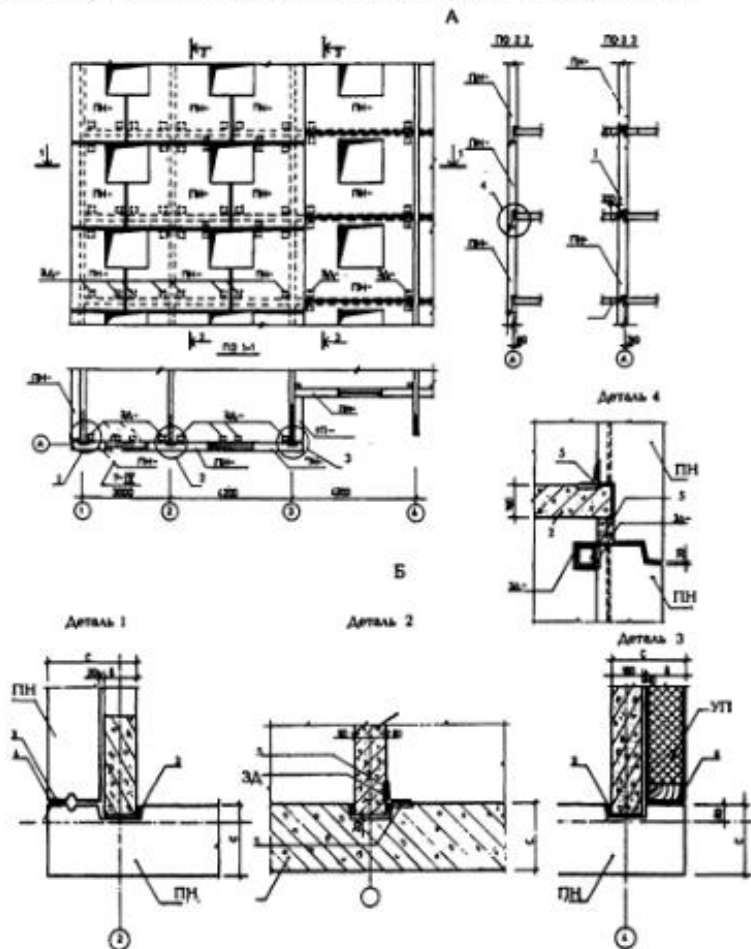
Панельные наружные стены монолитных зданий: а - монтажная схема раскладки панелей наружных стен специфической разрезки; б - узлы сопряжений панелей с внутренними монолитными конструкциями; ПН - легкобетонная панель наружной стены; УП - утепляющая панель из небетонных материалов в ризалите; ЗД - закладная деталь; Д - деревянный каркас, утепляющие панели; 1 - внутренняя монолитная стена; 2 - перекрытие; 3 - упругая прокладка; 4 - герметик; 5 - стальная связевая накладка
